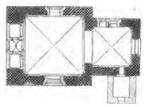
Stoltenbagen. Kirche. Grundriss. 1:667.
